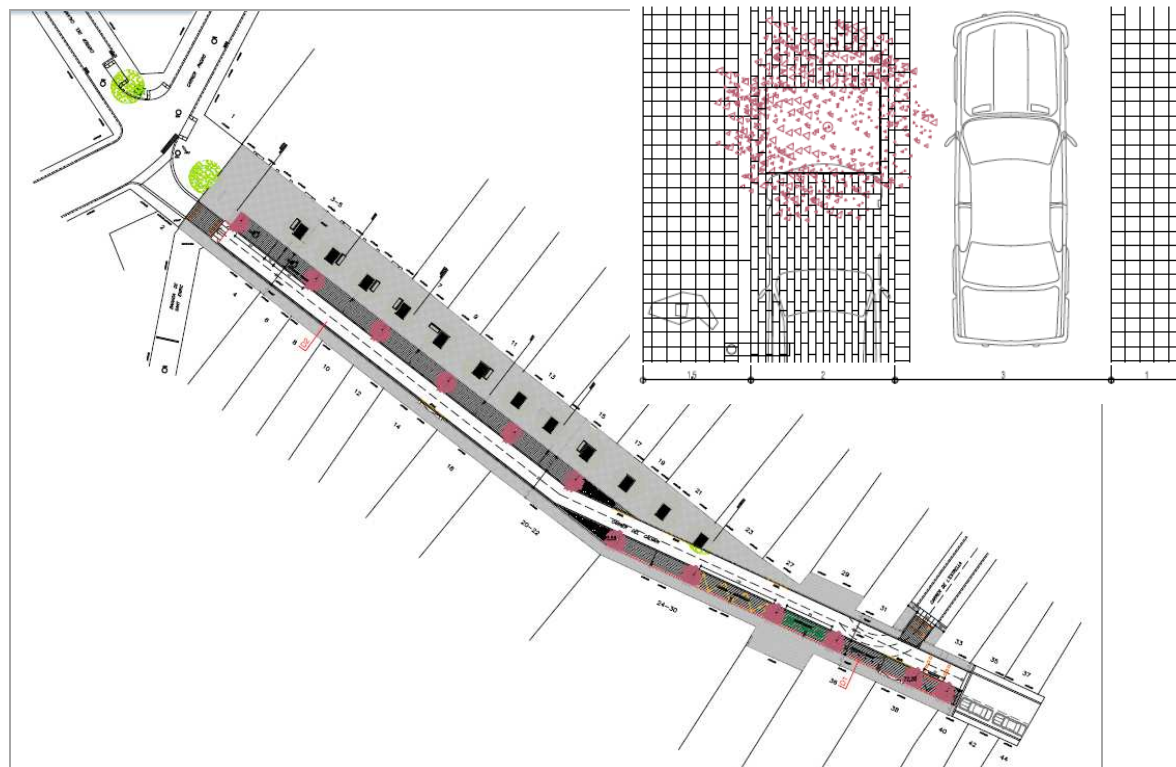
Disseny en planta i detall d'una de les seccions del c. Calvari
